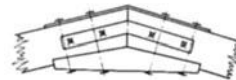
Druckstoß unter Verwendung einer Knagge und Flachstahlbändern.
